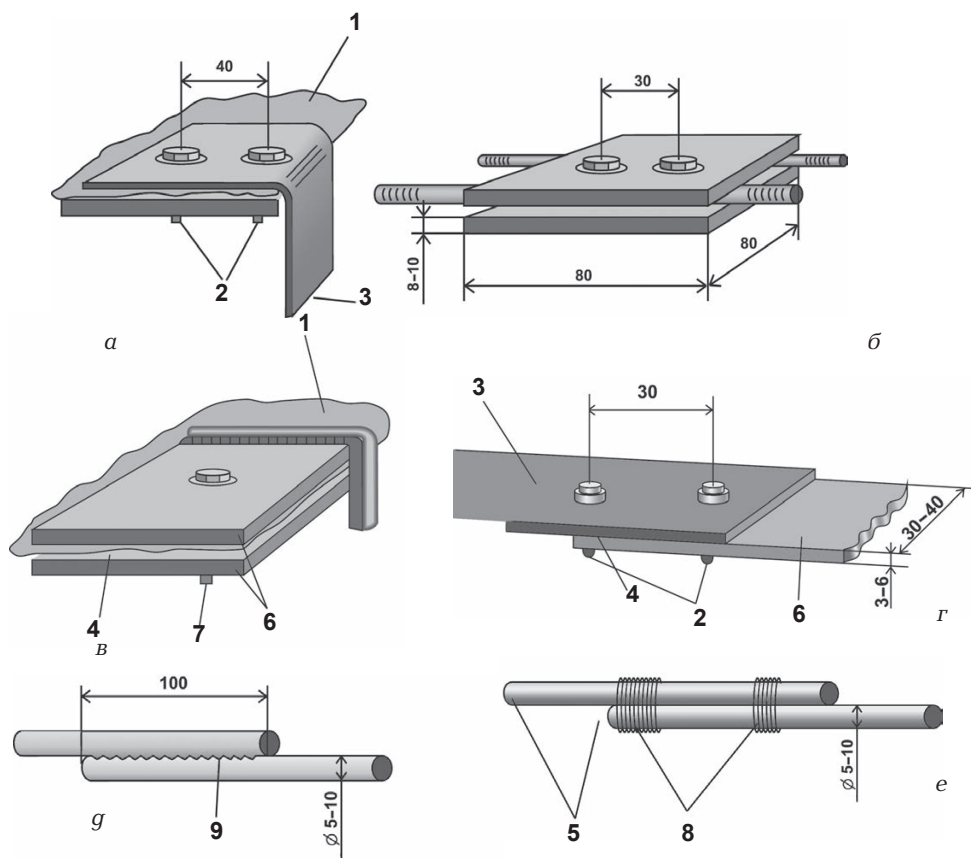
Варианты присоединения токоотводов к металлической кровле и между собой (мм): а, б, в, г — изготовление токоприемника из полосовой стали; г — соединение металлической проволоки токоотвода сваркой; е — соединение металлической проволоки токоотвода с помощью тонкой проволоки; 1 — кровля; 2 — болт М8 — М10; 3 — полосовая сталь; 4 — свинцовая прокладка; 5 — проволока диаметром 5–10; 6 — стальная пластина; 7 — болт М16; 8 — бандаж из оцинкованной проволоки диаметром 1,5–2,5 мм; 9 — сварка
